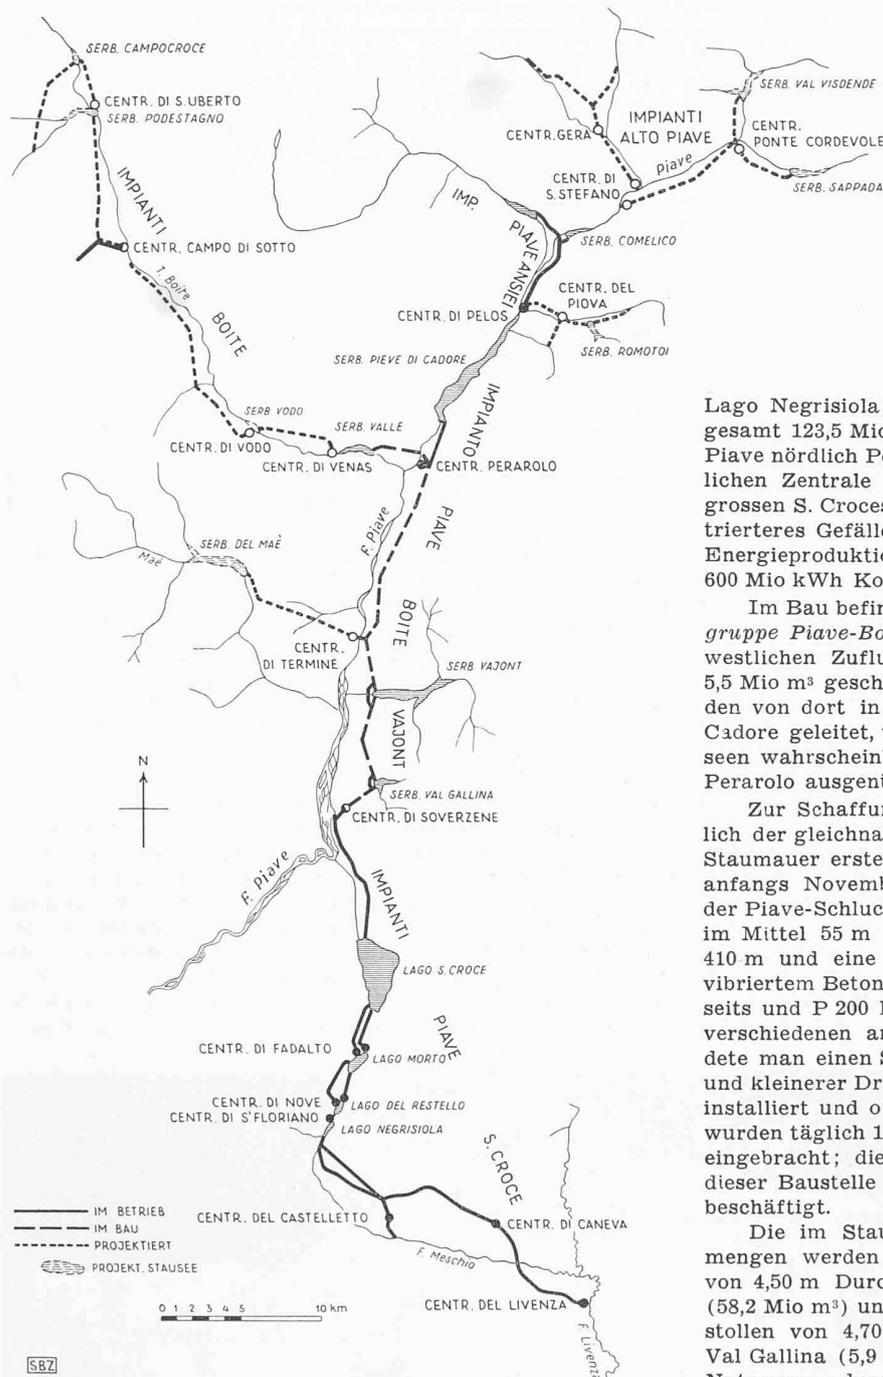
Kraftwerkgruppe am Piave und Boite. Lageplan 1: 450 000
